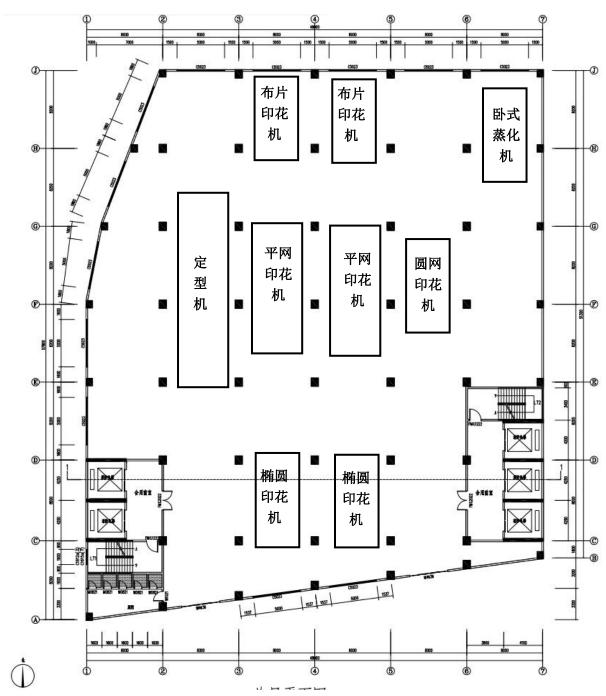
原有项目 (B 栋厂房) 7 楼平面布置图
